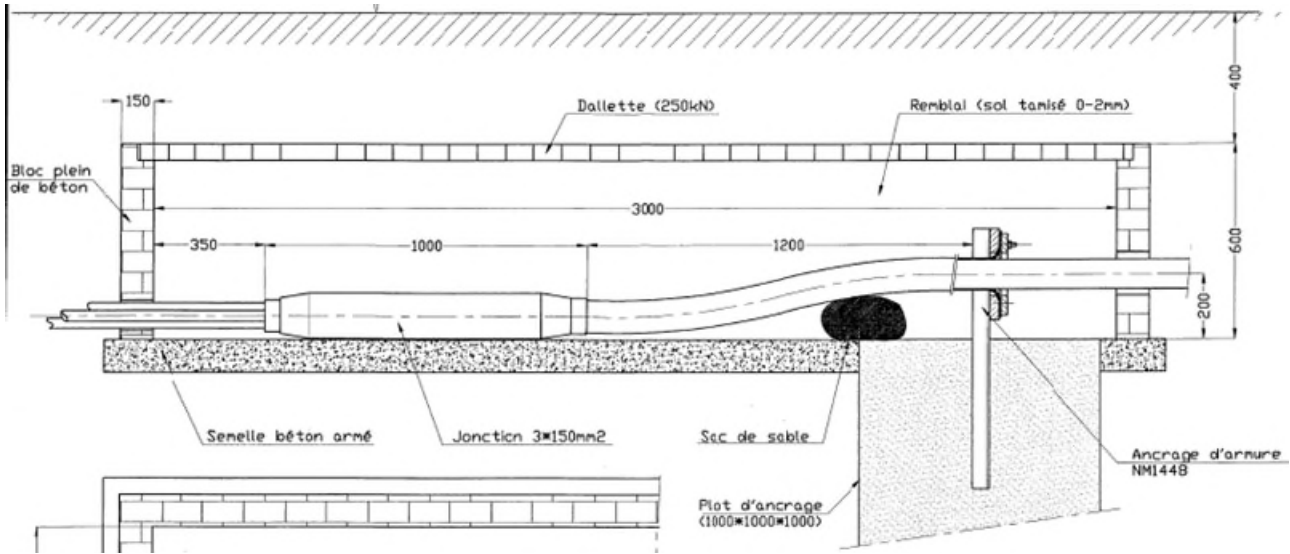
PLAN DE COUPE D'UNE CHAMBRE D'ATTERRAGE
